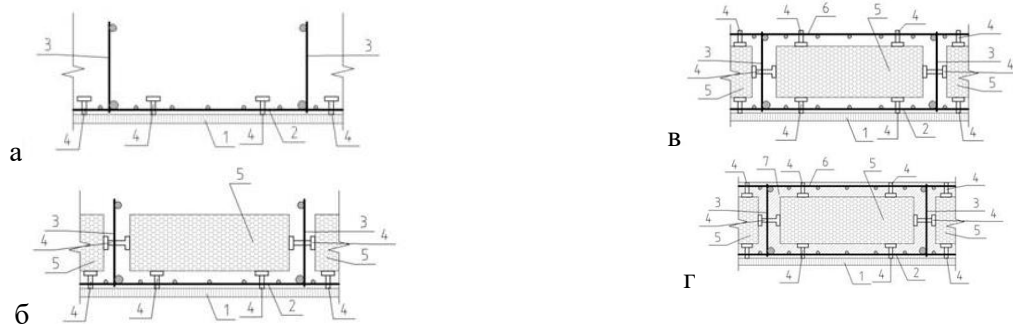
Технологія улаштування полегшеної конструкції залізобетонної плитної прогонової будови із застосуванням СУБС: а–г – технологічні операції; 1 – опалубка; 2 – арматура нижньої сітки; 3 – арматурні каркаси; 4 – фіксатори вкладки; 5 – вкладки; 6 – арматура верхньої сітки; 7 – СУБС [29]
